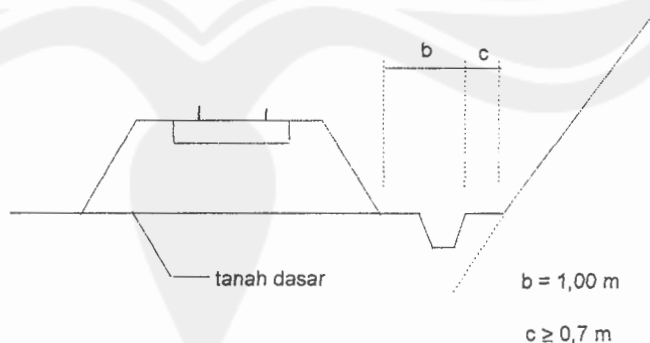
Tubuh Jalan Rel pada Timbunan
